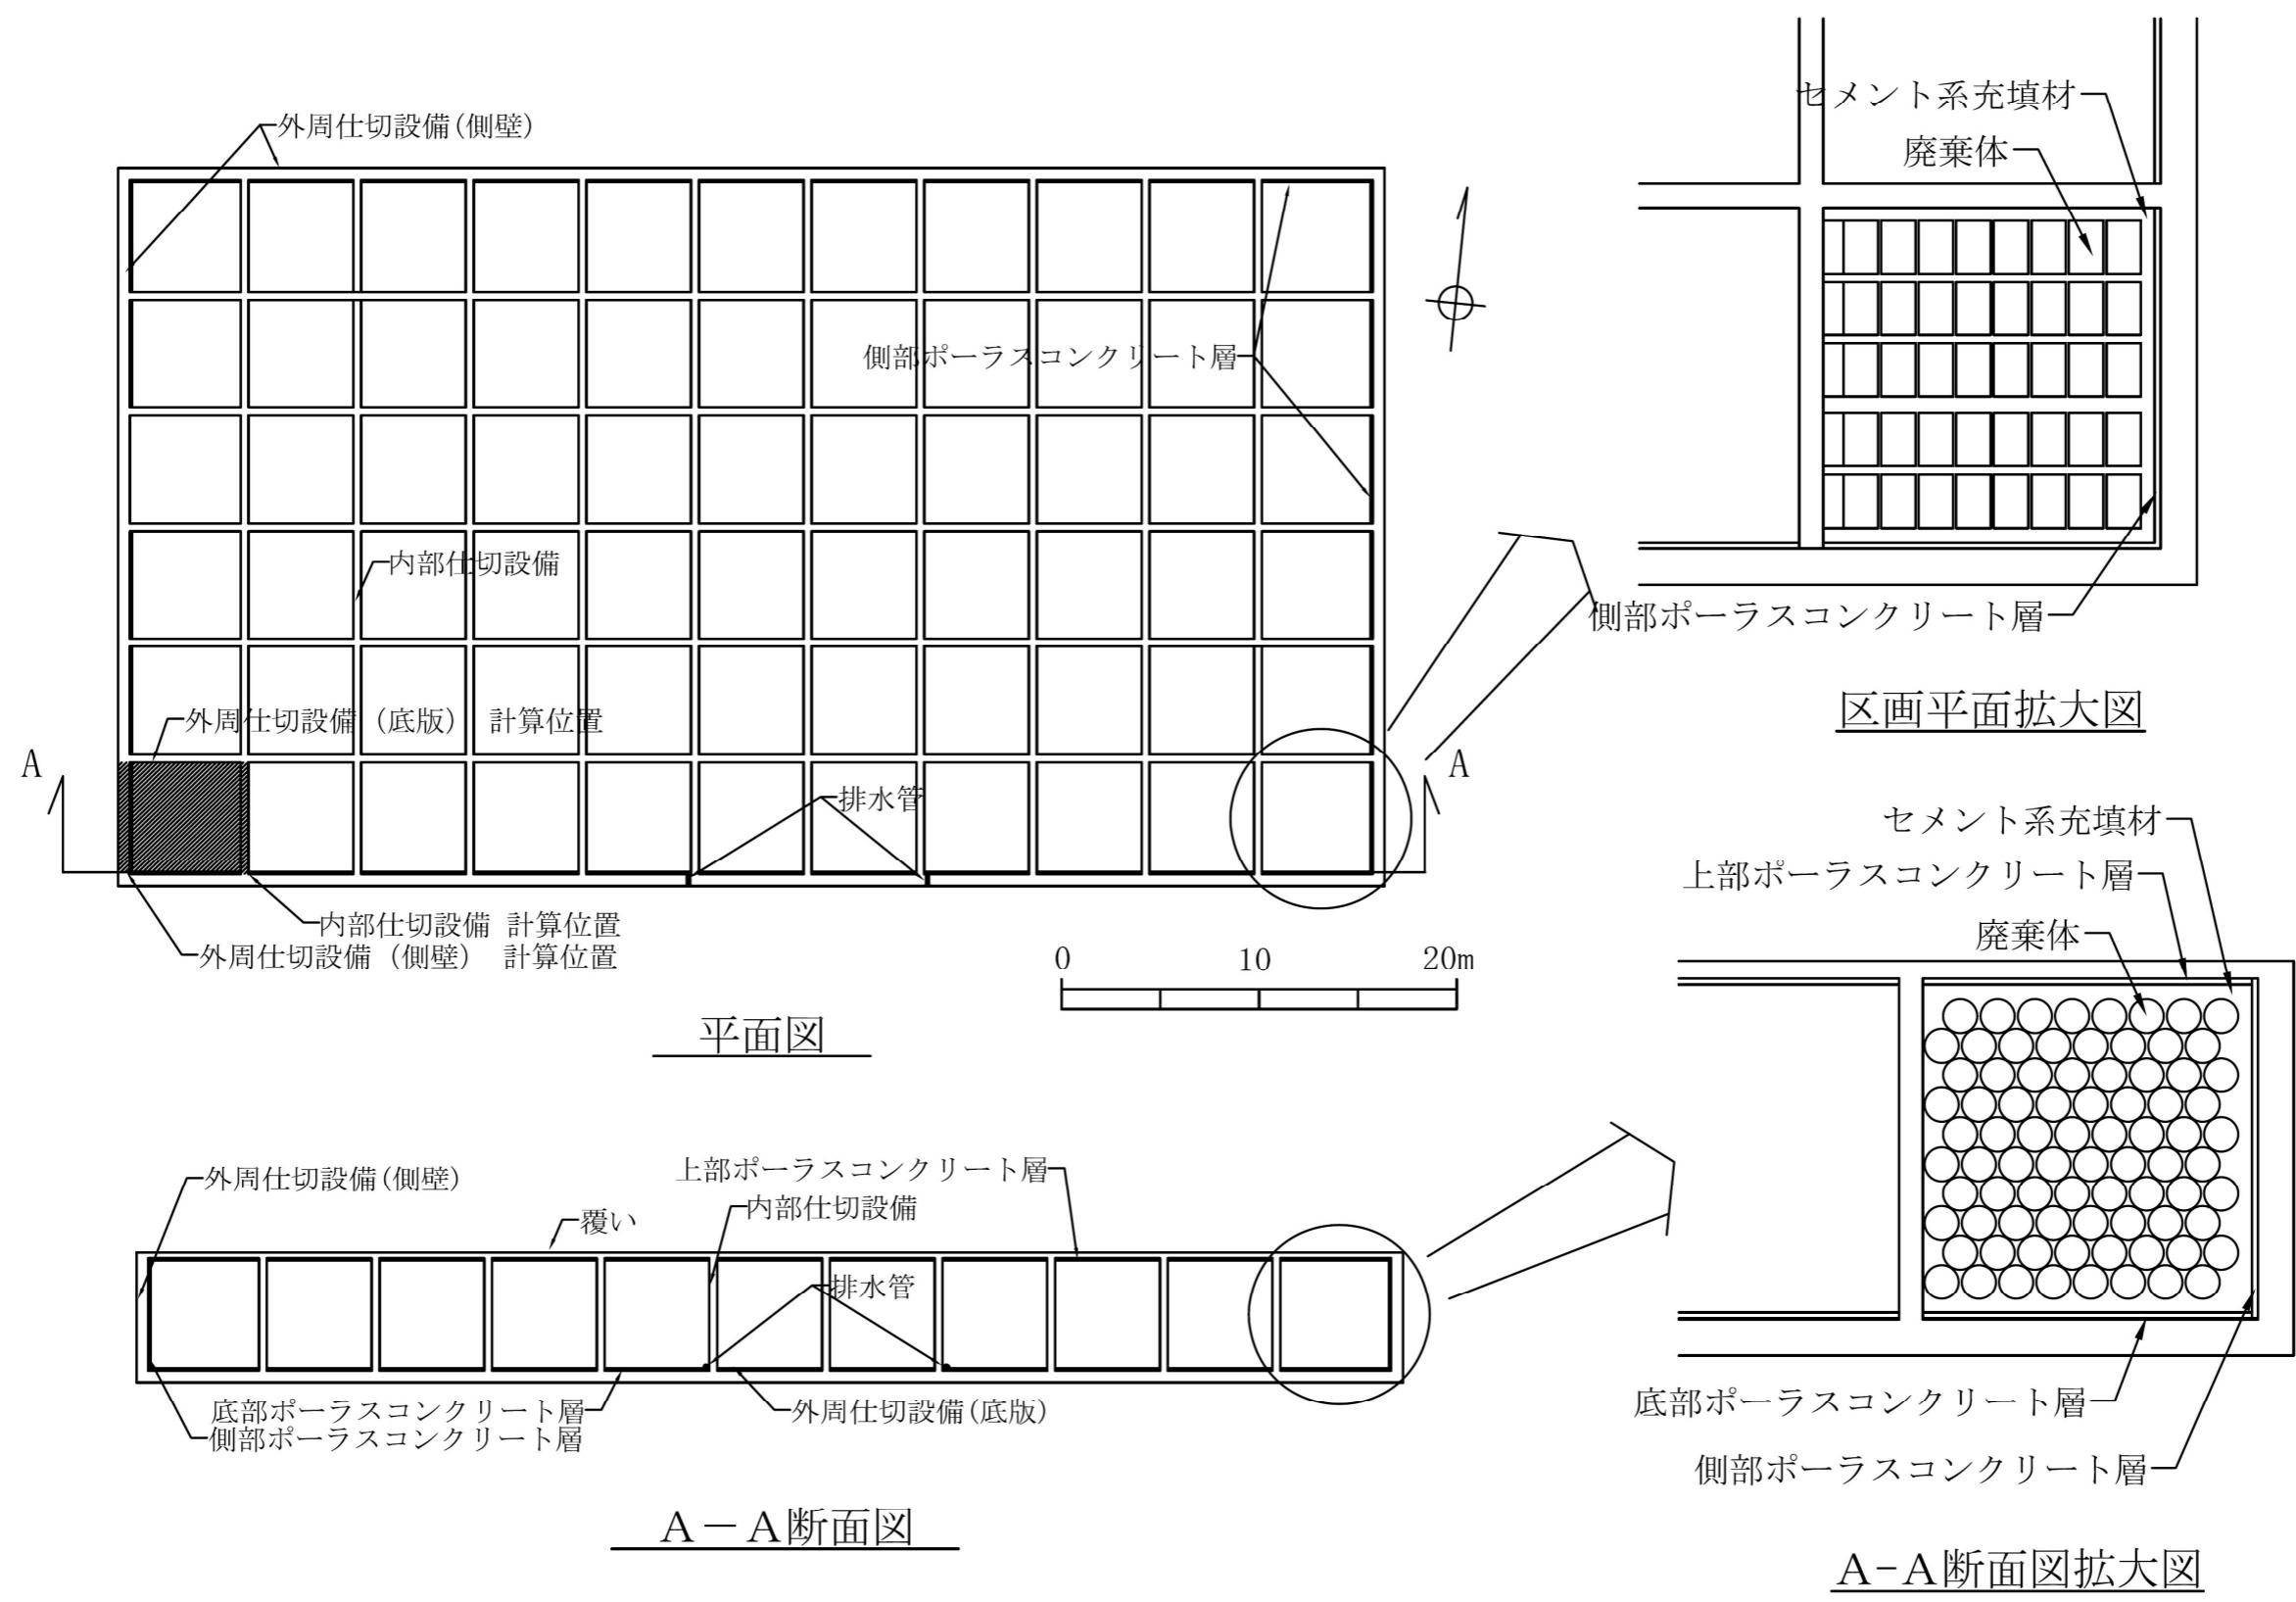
イ (ハ)-2 埋設設備の配置図(断面)
